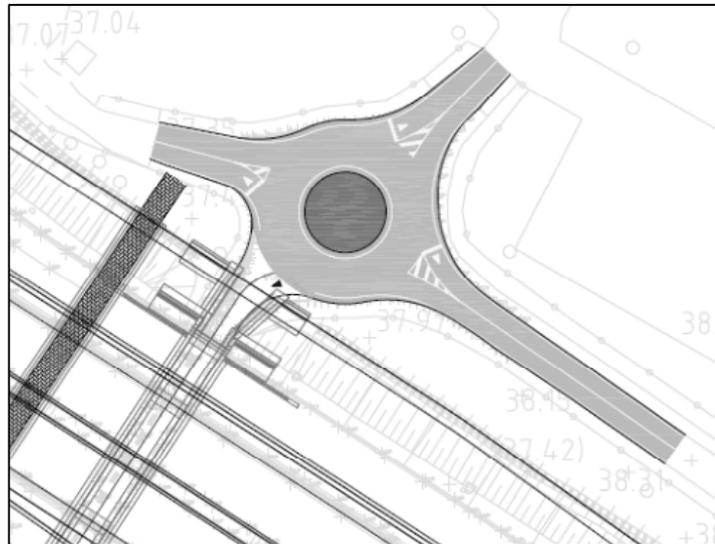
Stralcio planimetrico rotonda via Zambeccari
